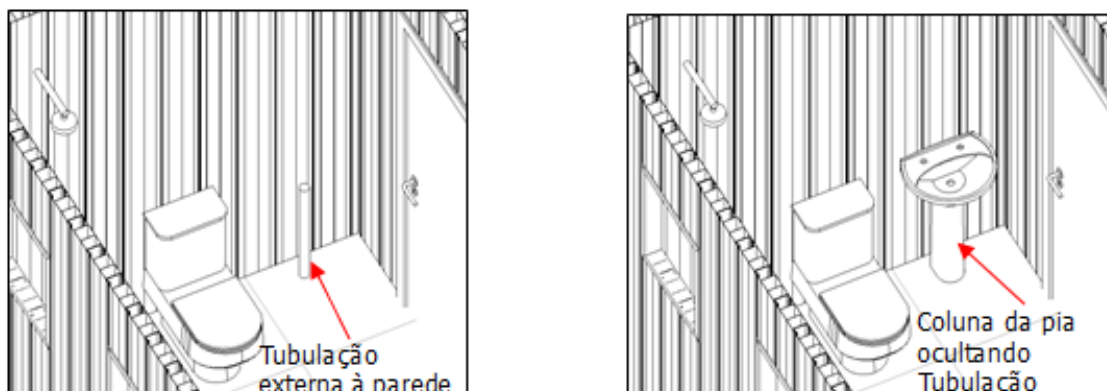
Ilustração de tubulação de esgoto externa à parede de *Concreto-PVC*. (Sem escala).
